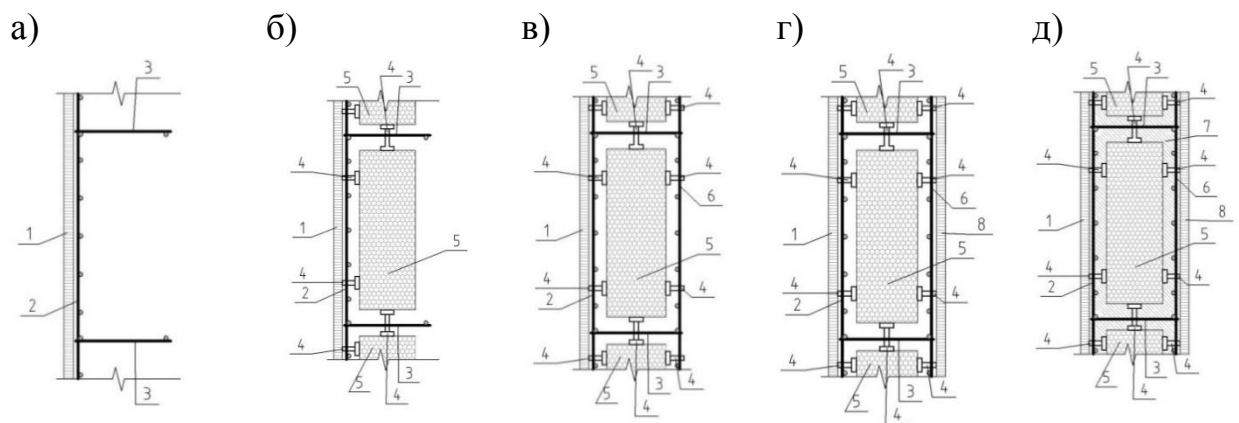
Безперервна технологія зведення вертикальних елементів: а) установка опалубки 1, арматурної сітки 2, арматурних каркасів 3; б) установка вкладишів 5 з фіксаторами 4; в) установка арматурної сітки 6 і фіксаторів 4; г) установка опалубки 8; д) бетонування стіни 7.
